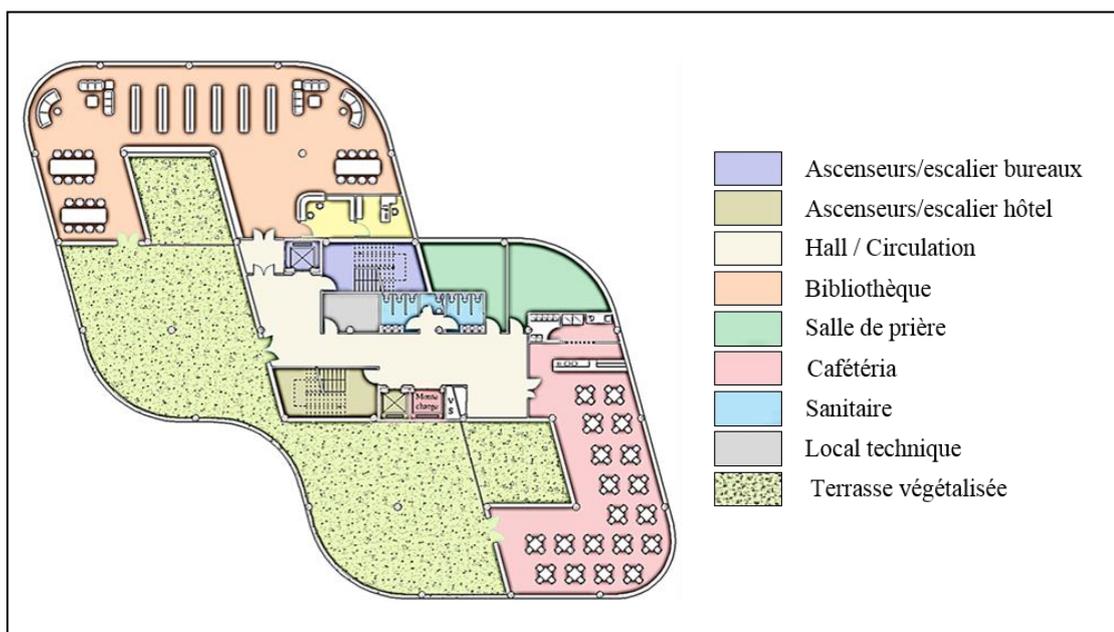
Plan 7^{ème} étage (source : auteurs)
